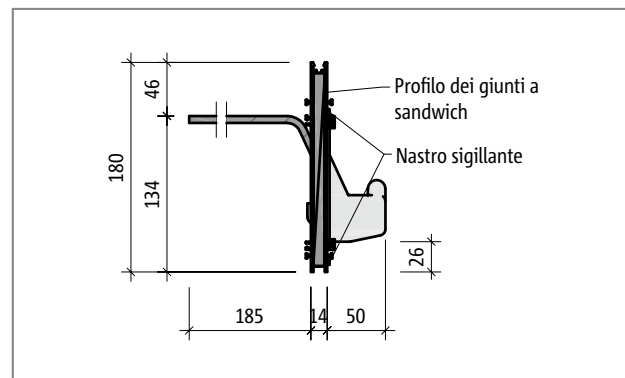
Schöck Tronsole® tipo T, sezione dell'elemento T...-H180
